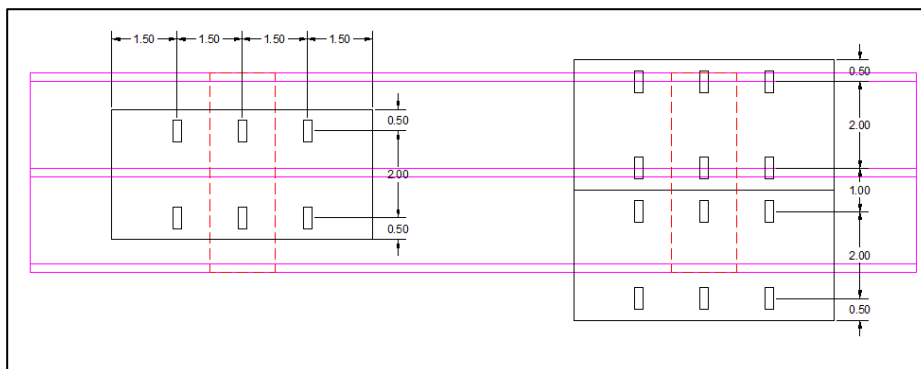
Carga móvel sobre a galeria - distribuição em planta do trem tipo.
